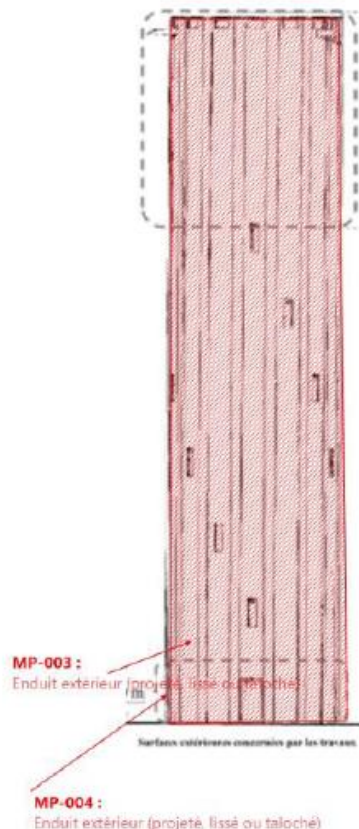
Présence d'amiante (en rouge) sur façade du bâtiment Z10
